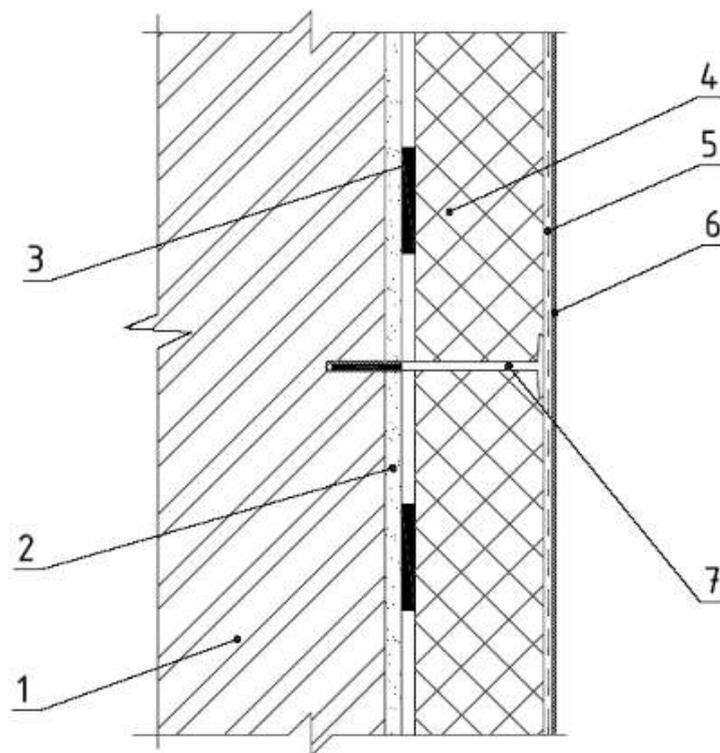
Схема утеплення з використанням тонкошарової штукатурки для опорядження (1 – стіна; 2 – шар штукатурки; 3 – шар клею; 4 – шар утеплювача; 5 – захисний шар; 6 – зовнішнє опорядження; 7 – механічне кріплення)
